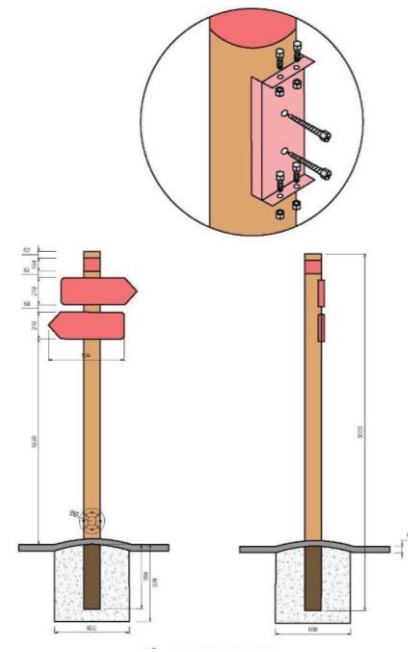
Señal direccional CN-03 (detalles en plano 12.3)
